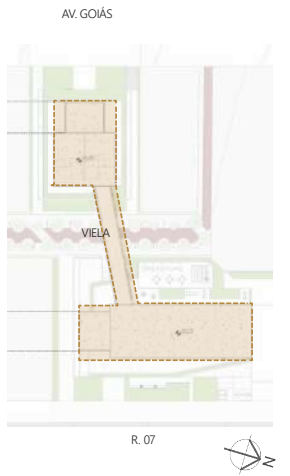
Planta Baixa do Nível 0 da TA, no 13º Pavimento
